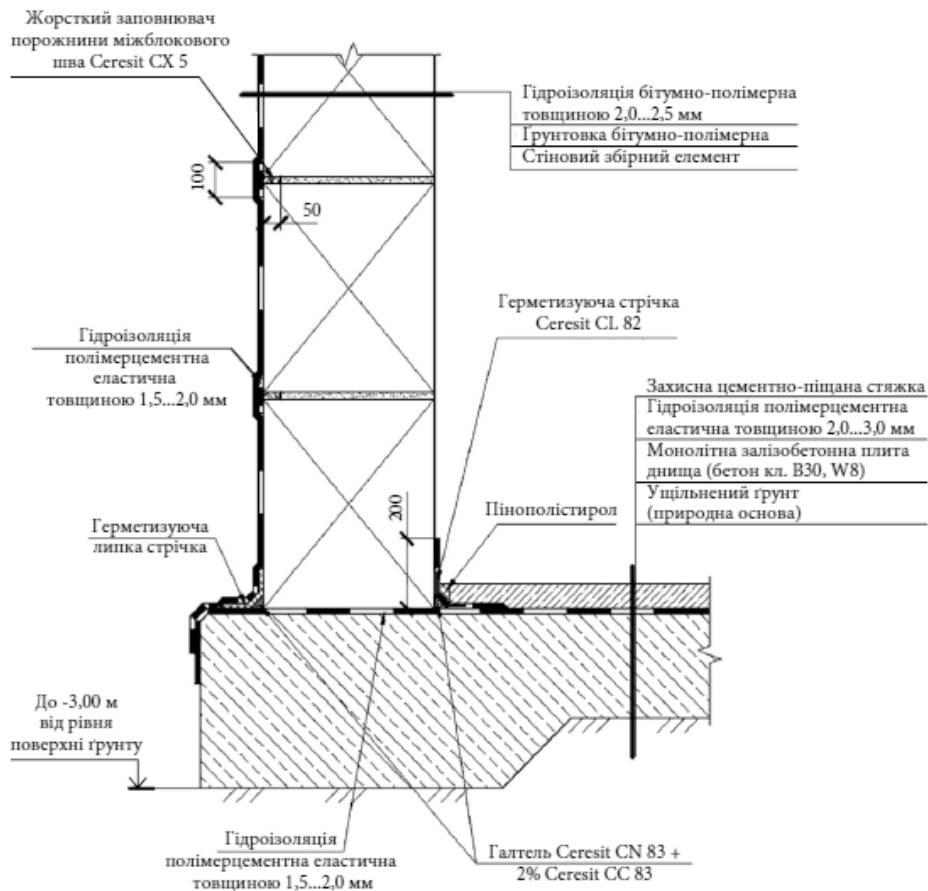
Гідроізоляція бетонних плит основи і стін підземних збірно- монолітних в умовах впливу ґрунтової вологи.
